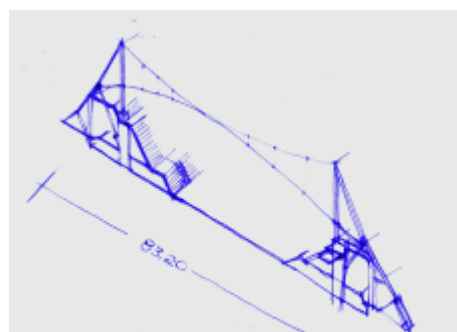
Sezione trasversale con individuazione degli elementi strutturali principali
